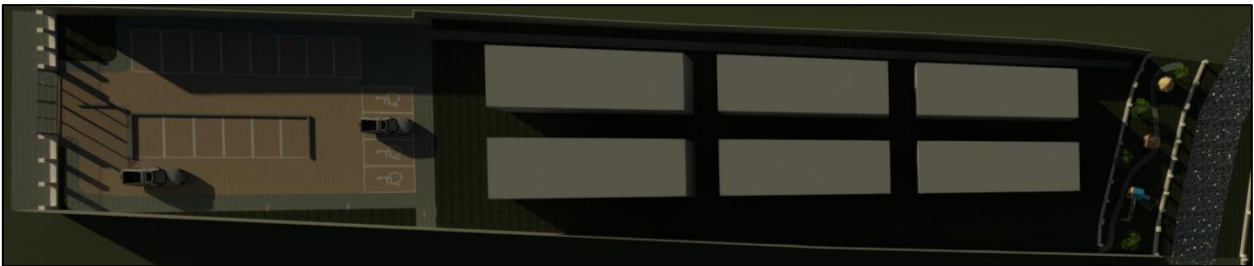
Propuesta de bloques para Sección 1 del Lote B
